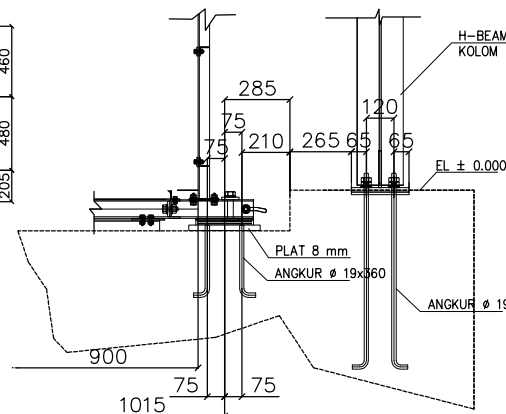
DETAIL DUDUKAN PILAR JEMBRAN GANTUNG BENTANG 84 M
